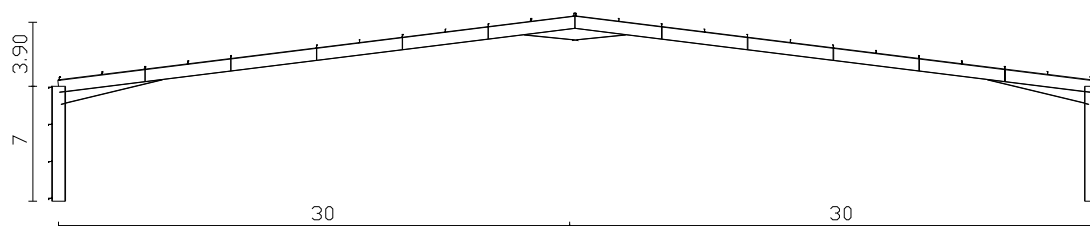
Pórtico rígido viga e pilar de alma cheia, vão de 60.00m com esquadros ligação pilar/viga, viga/viga
